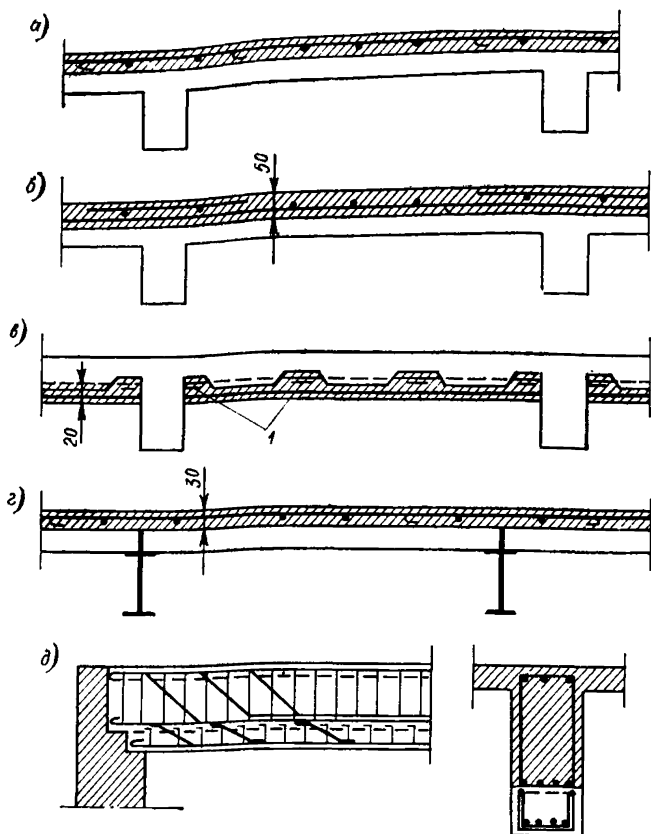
Усиление монолитных железобетонных перекрытий
